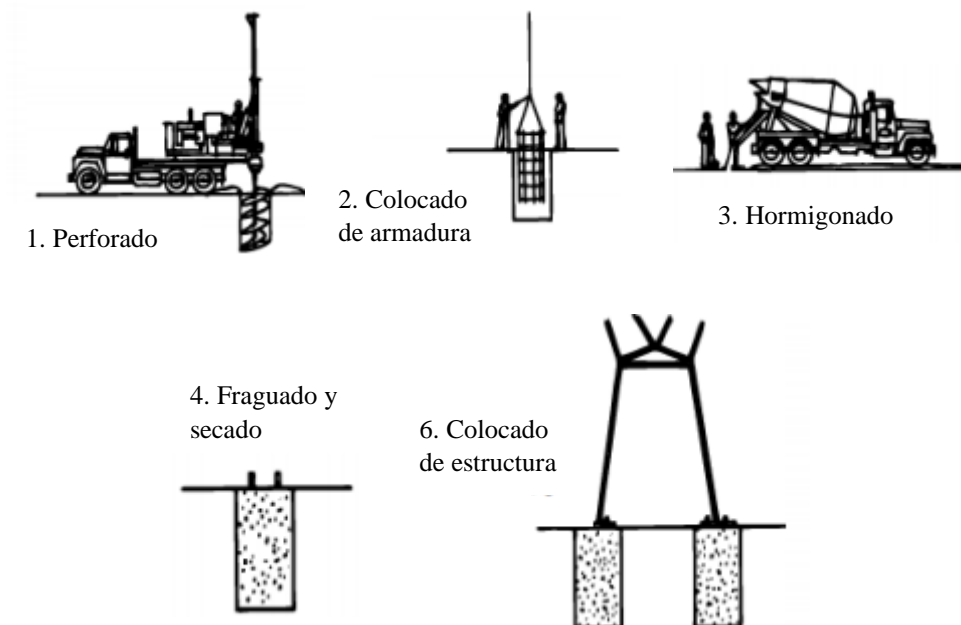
Construcción tradicional de pilotes de hormigón armado
